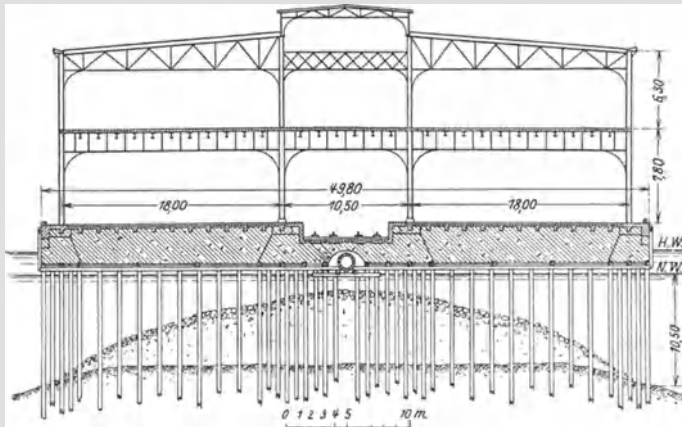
Zweigeschossige Eisenbahn-Pier im Hafen von New York. Maßstab 1:620.
